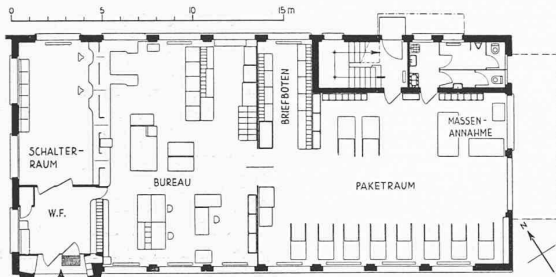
Postgebäude Wallisellen, Erdgeschoss 1:400
